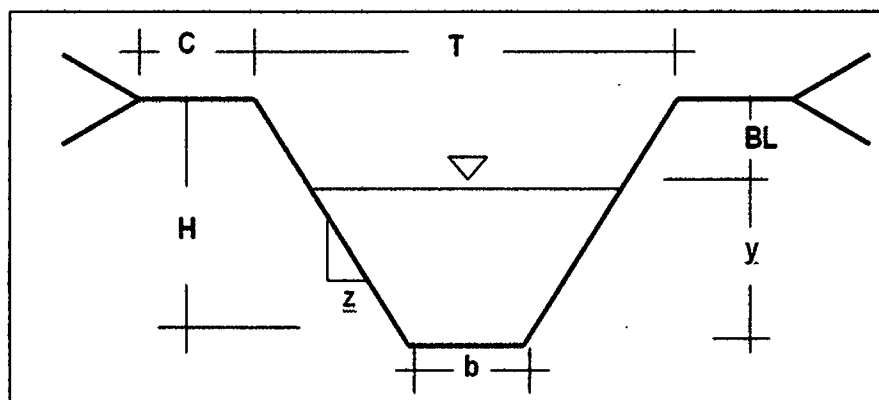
Elementos geométricos de la sección transversal de un canal
